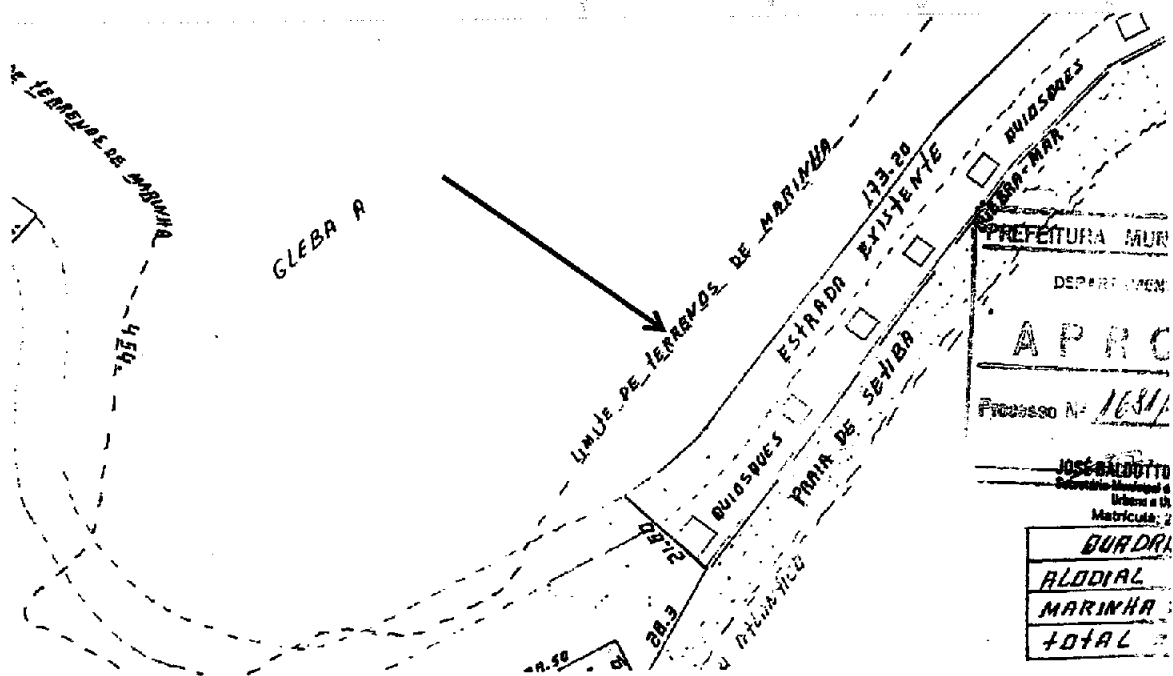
Foto F: Marcação do Terreno de Marinha em Planta Aprovada na Prefeitura (fonte: Solicitante)
